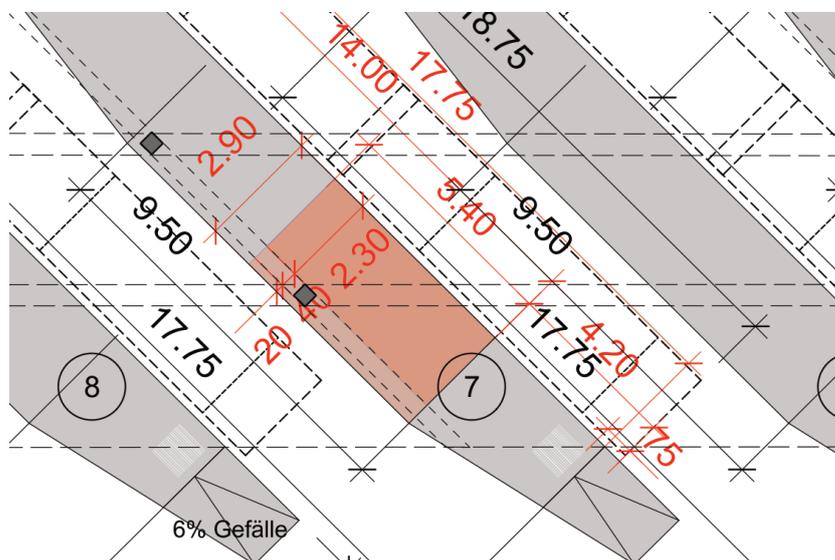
Skizze Busperron mit Rollstuhl- Manövrierfläche mit einer minimalen Breite von 2.30 m
